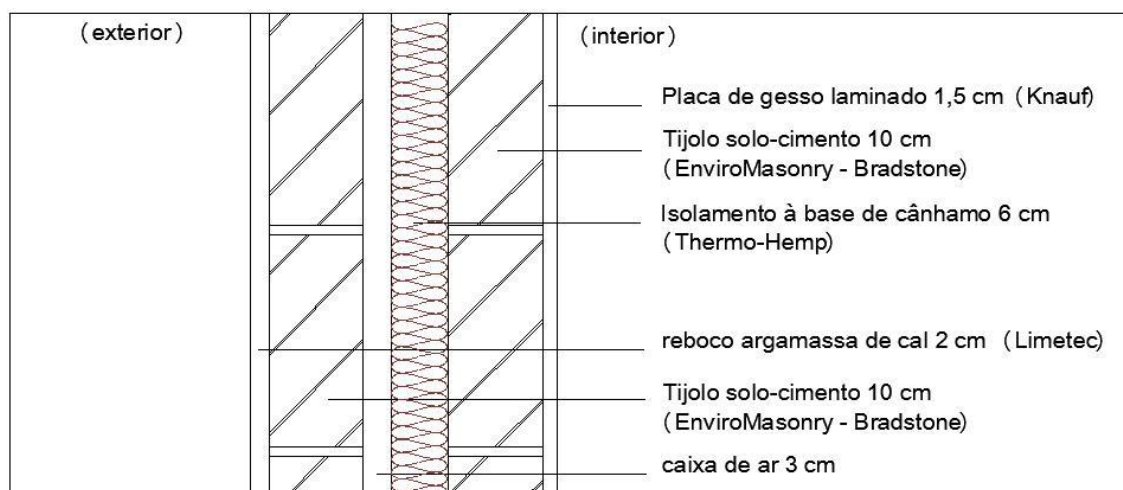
Pormenor construtivo de parede exterior proposta na solução 1
